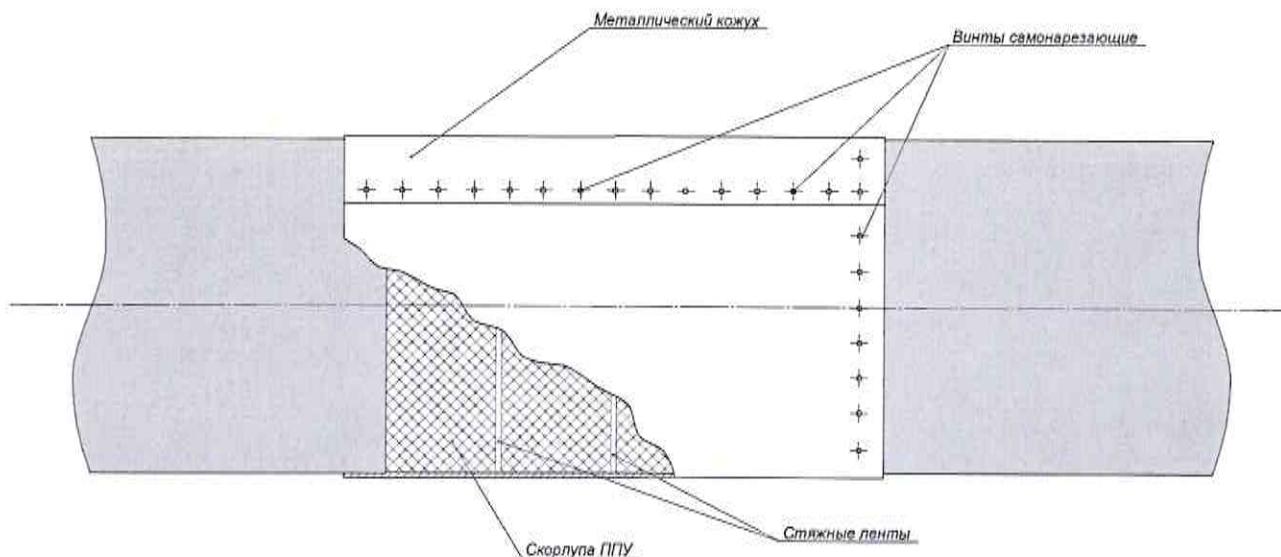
Крепление кожуха для теплоизоляции сварного стыка труб подземной прокладки.
